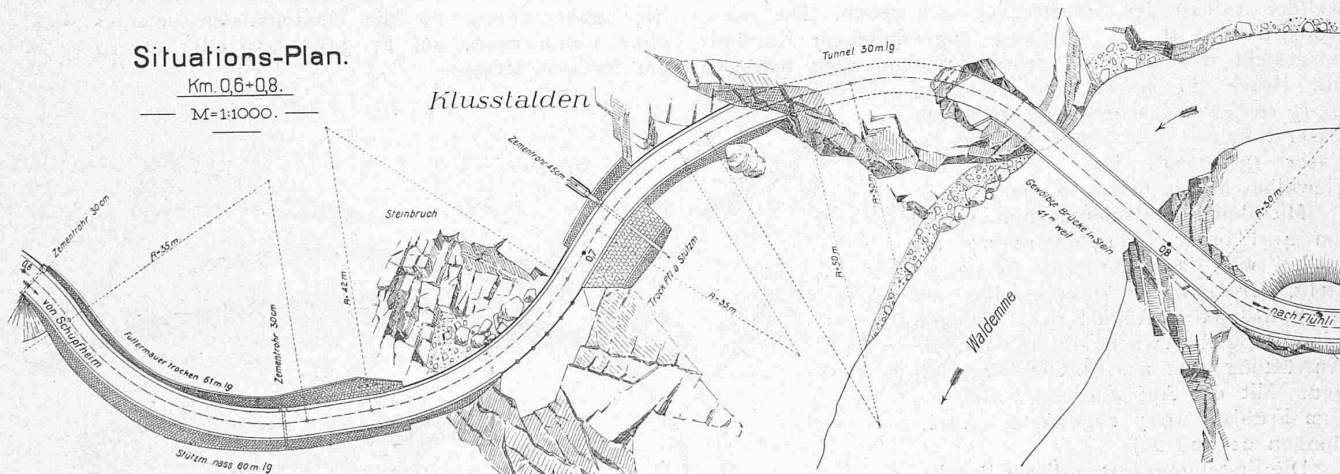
Lageplan Km. 0,6 bis 0,83, — 1:1000.
